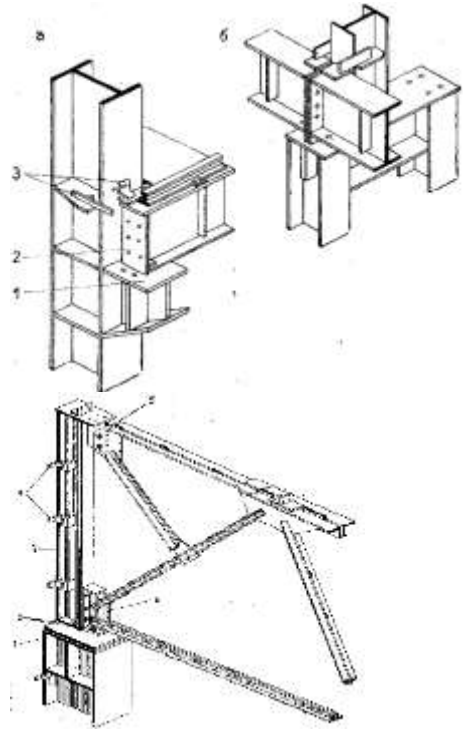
Кріплення сталевих підкранових балок до сталевих колон: а – до крайньої колони; б – до середньої колони; 1 – консоль колони; 2 – опорне ребро підкранової балки; 3 – кріпильні планки.
